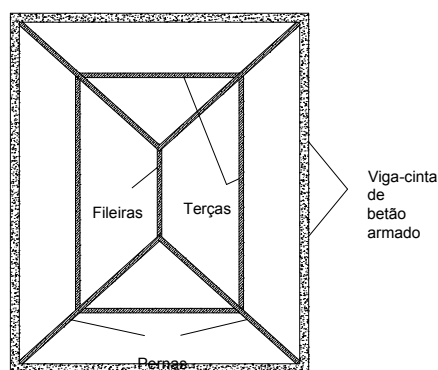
Planta da cobertura, com elementos estruturais principais.
